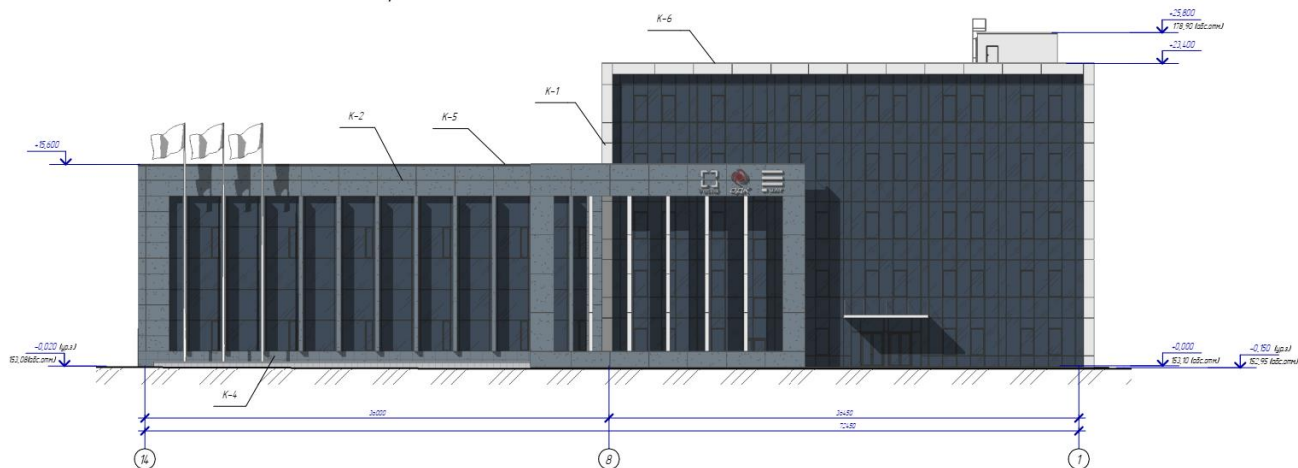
Схема фасада по оси 1-14 (фронтальный вид)
